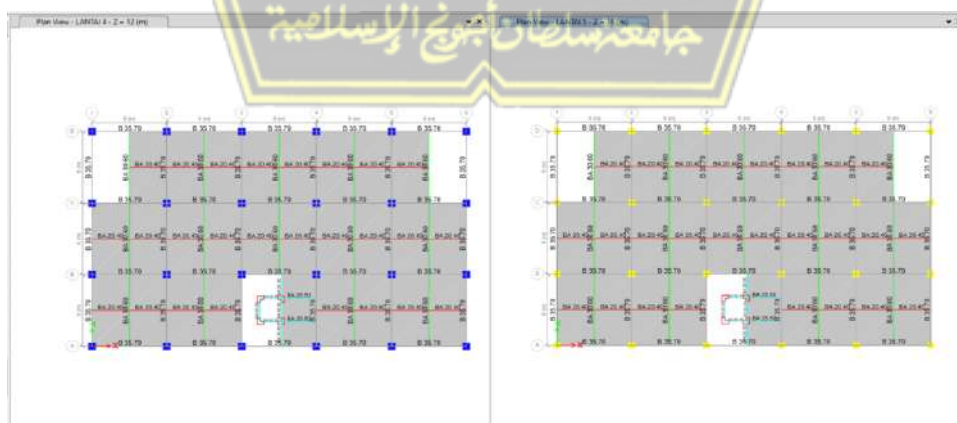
Denah Kolom Lantai 6 dan Lantai 7
